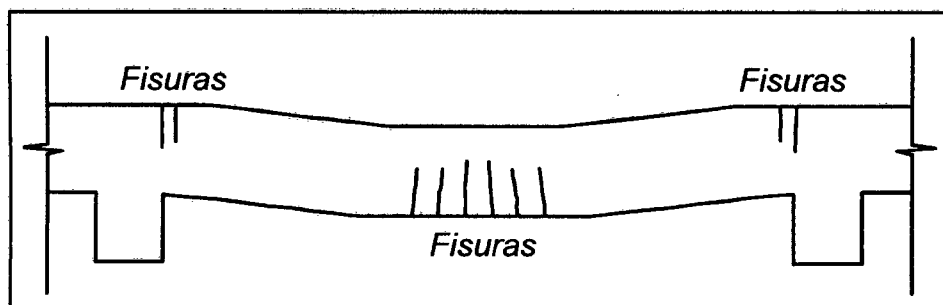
Fisuración por esfuerzos de tracción en vigas (Pérez 2008).
